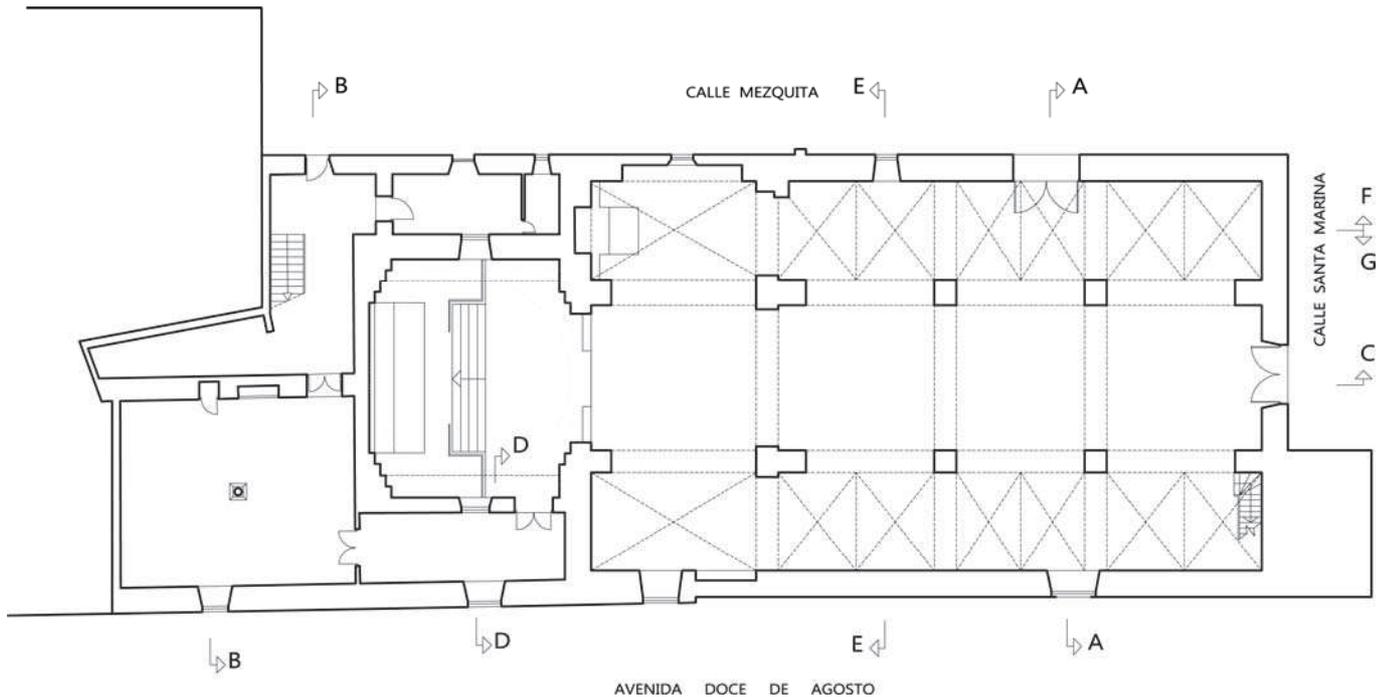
Planta general de la iglesia, con indicación de las secciones realizadas
